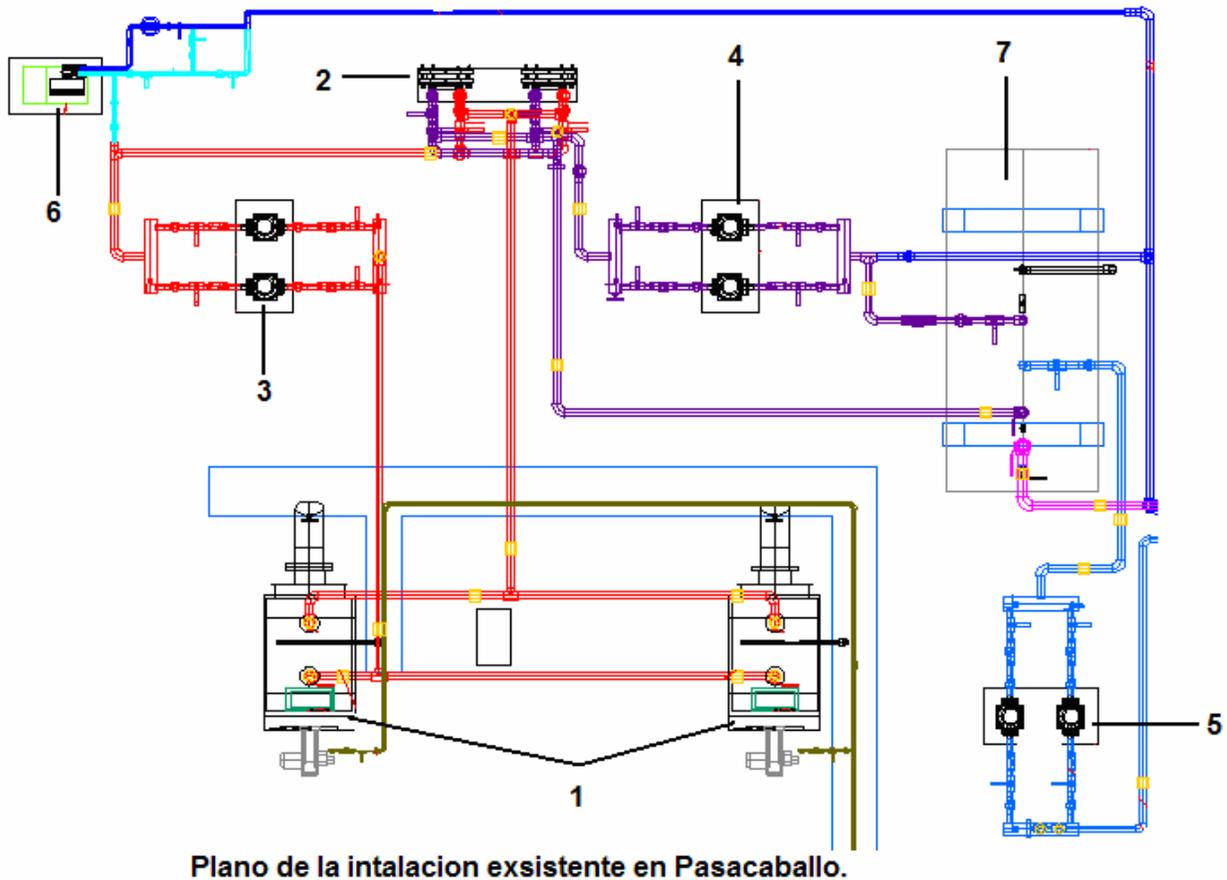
Plano en planta de la instalación existente en el Hotel Pasacaballo para el calentamiento de agua.
